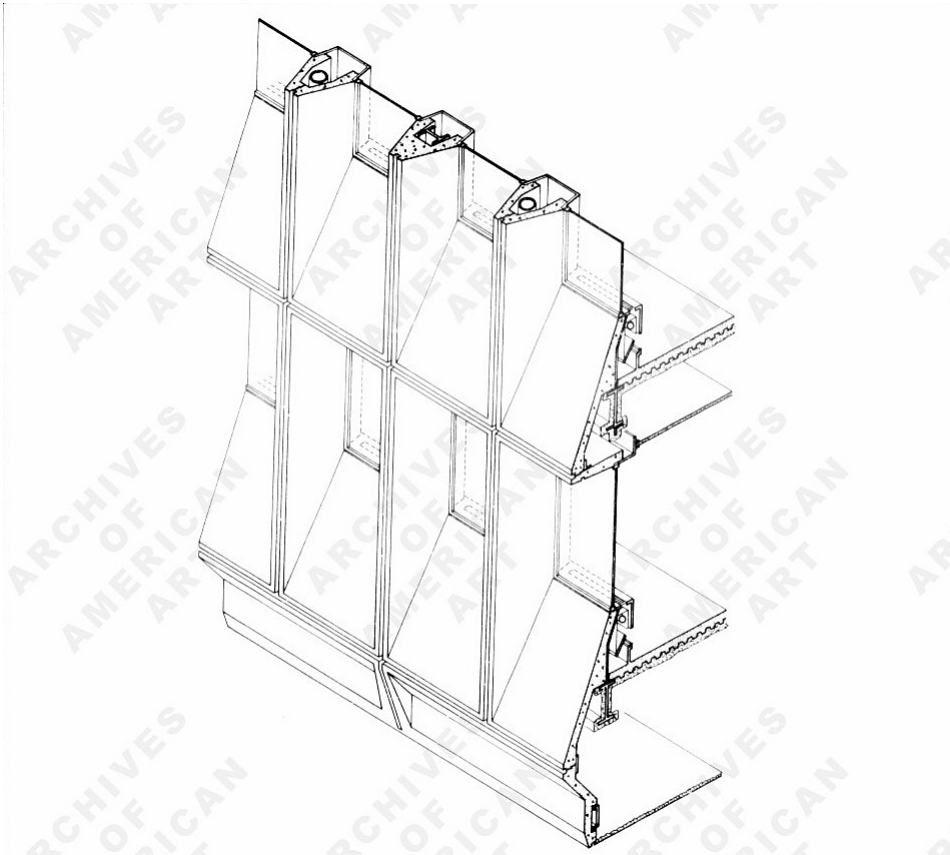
M. Breuer y R. F. Gatje, Armstrong Rubber Company, en West Haven, Connecticut, Estados Unidos, 1965-1969. Detalle de los prefabricados y la estructura de la fachada.
